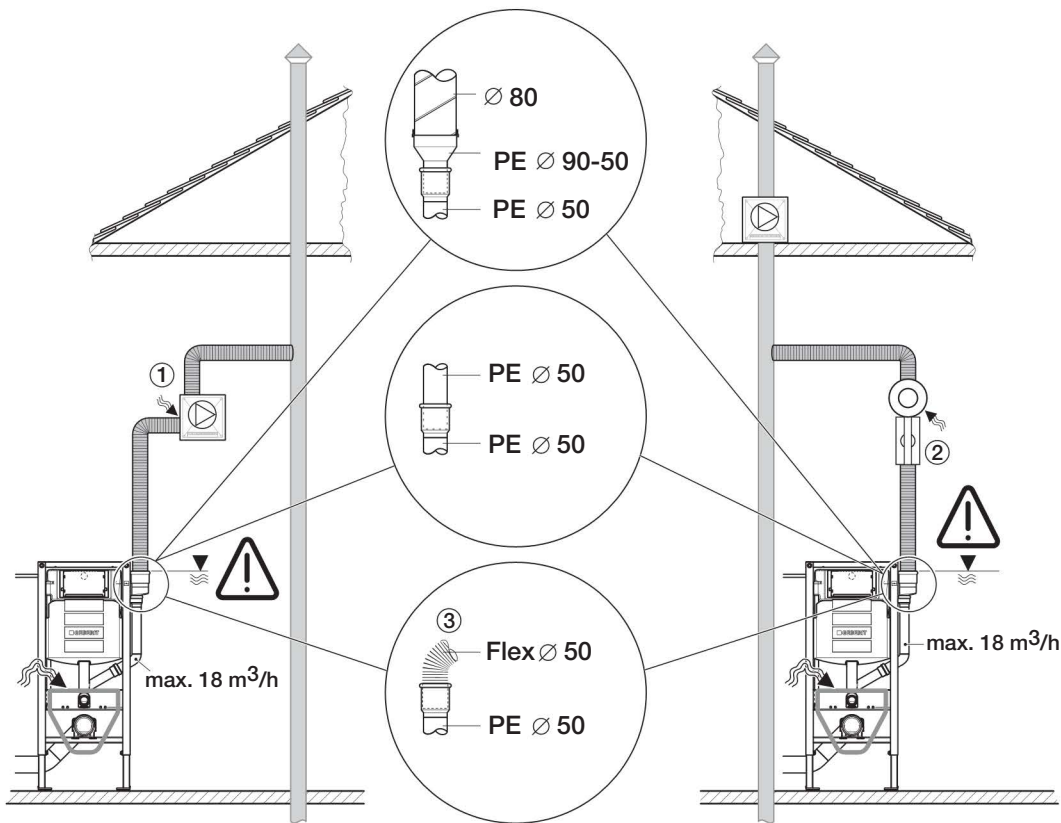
Schema WC-Installationselemente mit Geruchsabsaugung
